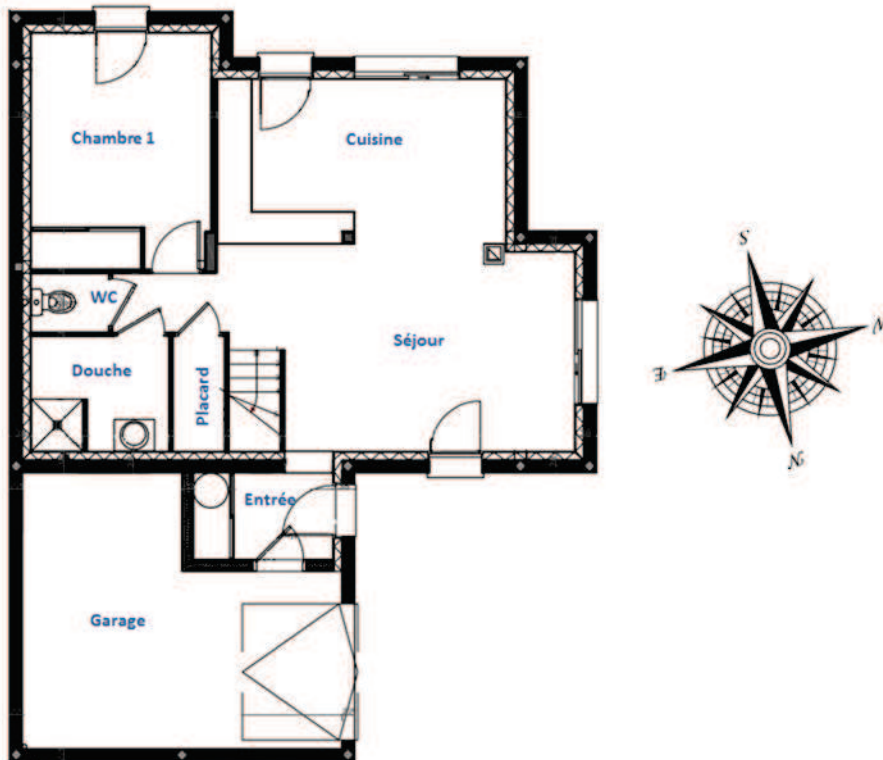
Plan du rez-de-chaussée de la maison expérimentale
